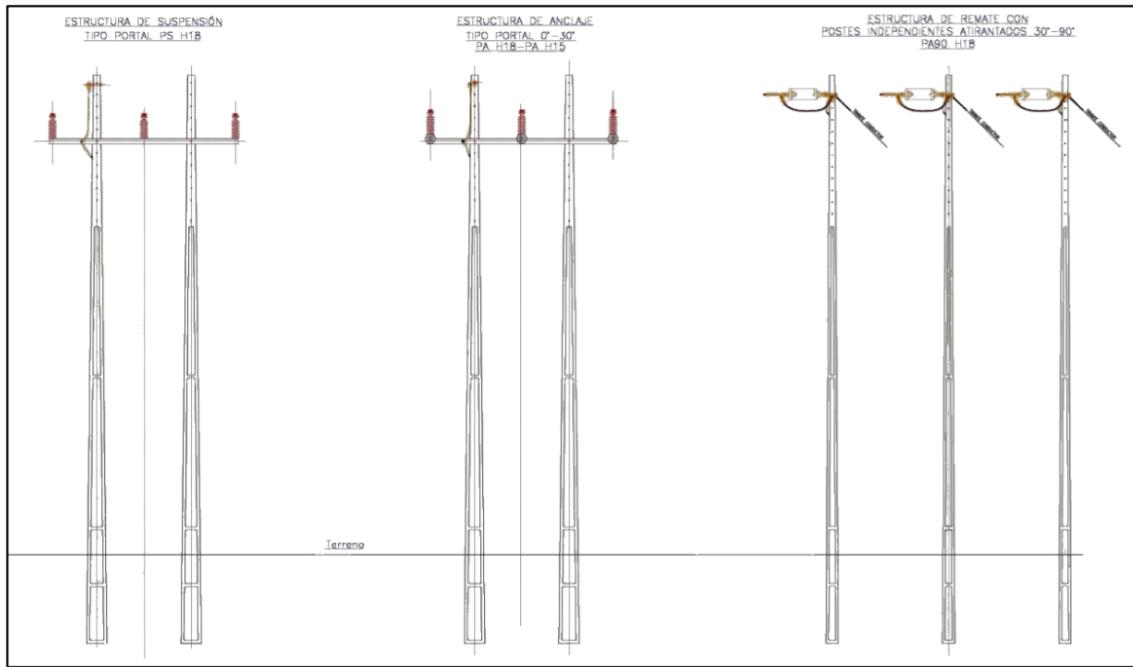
Siluetas de estructuras de suspensión y anclaje.
